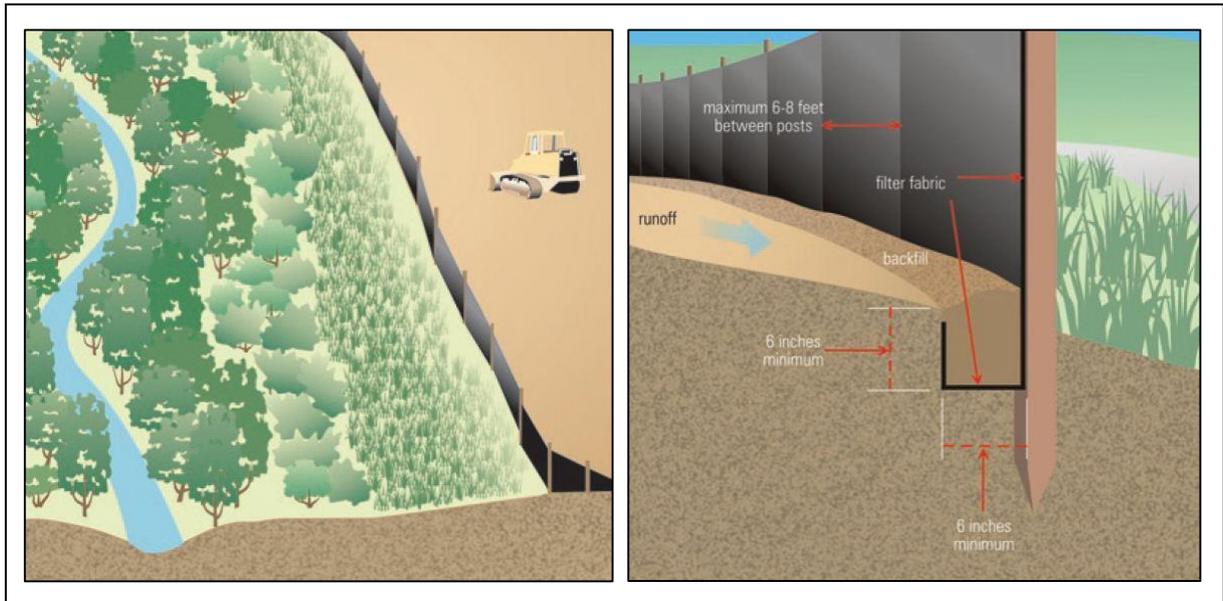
esempio di recinzione impermeabilizzante e particolare dell'installazione. Immagini tratte da : *Developing Your Stormwater Pollution Prevention Plan. A Guide for Construction Sites
